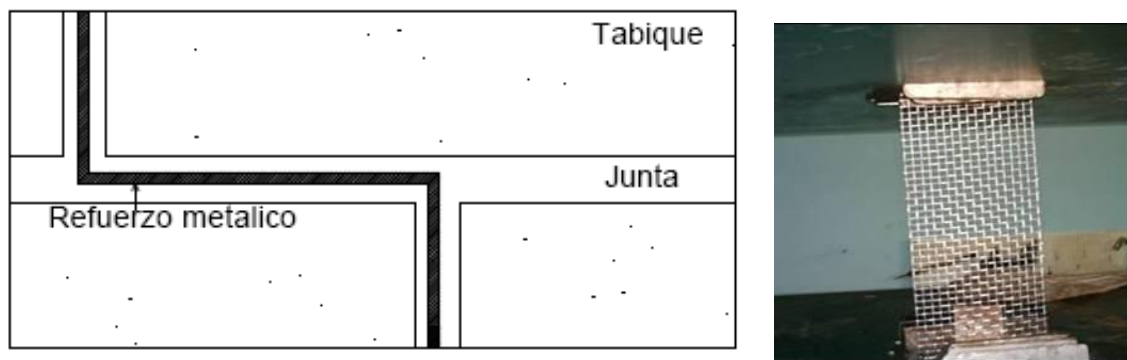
Refuerzo metálico en juntas de mortero (Fuente: Sánchez et al., 2007)
